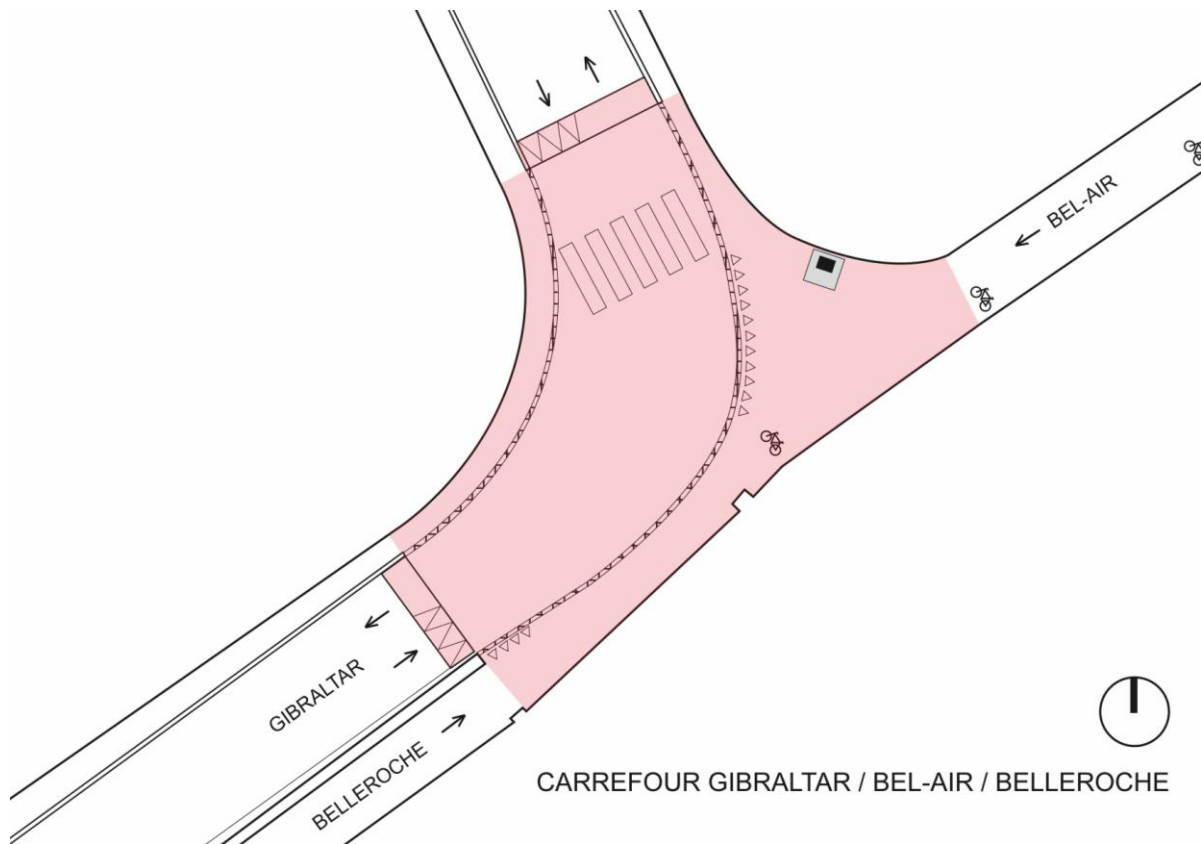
plan du carrefour Gibraltar/Bel-Air/Belleruche
